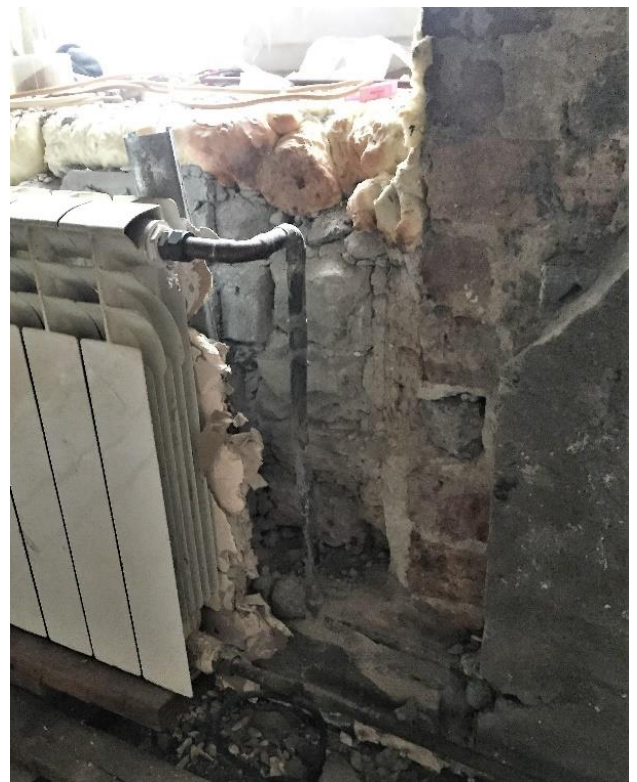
Разрушение кладки из силикатного кирпича межоконного простенка, растворных швов в поясе кладки под окнами.
